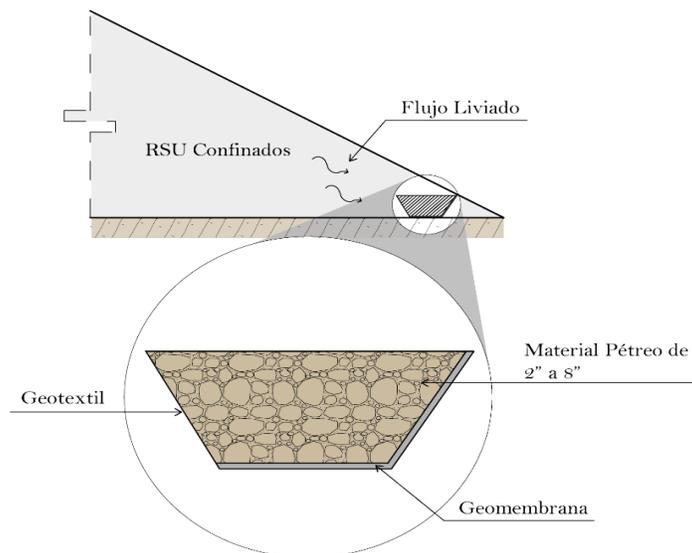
Diagrama de alternativa A de dren perimetral recubierto con geomembrana para la captación de lixiviado a pie de talud
